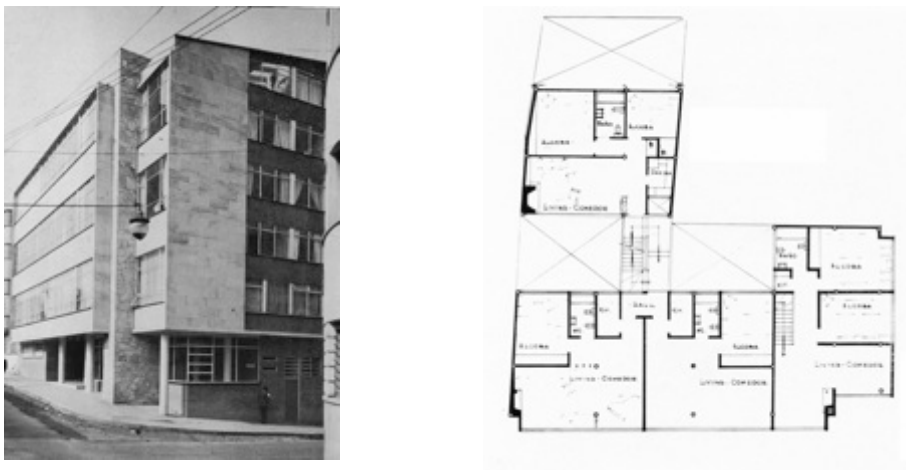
Edificio para la Beneficencia de Cundinamarca – Fachada y Planta de segundo nivel –
